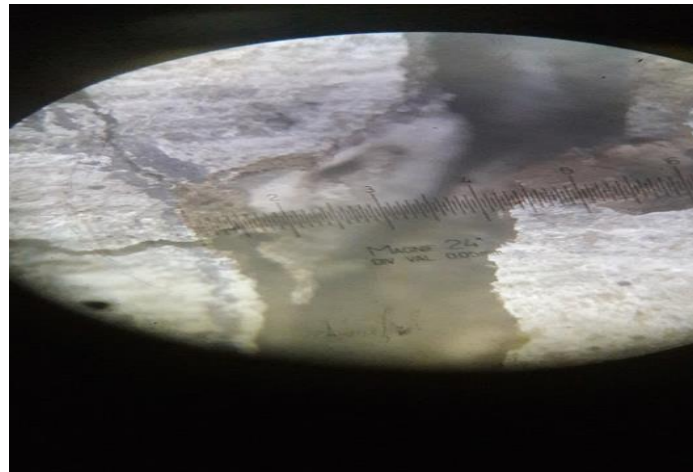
Mesure Dernière fissure sur la poutre en béton fibré et ferrillé
